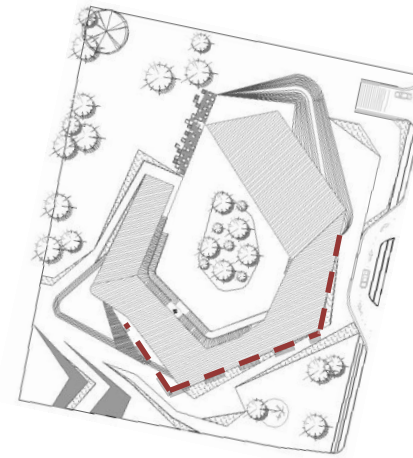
Planta de tratamiento de aguas jabonosas
